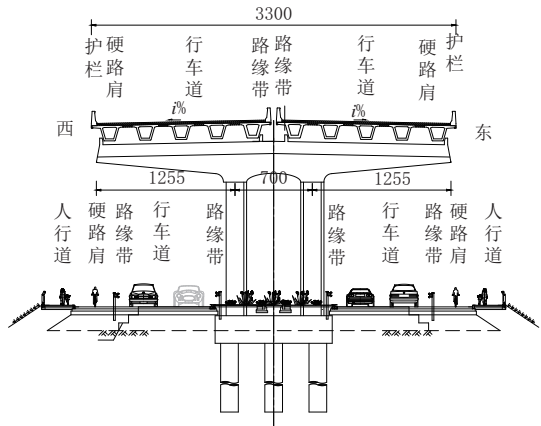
横断面布置图(魏俞公路—新华路段)(单位:mm)
